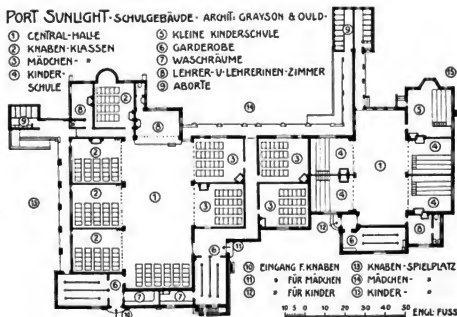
Port Sunlight, Grundriß des Schulgebäudes in Park Road
